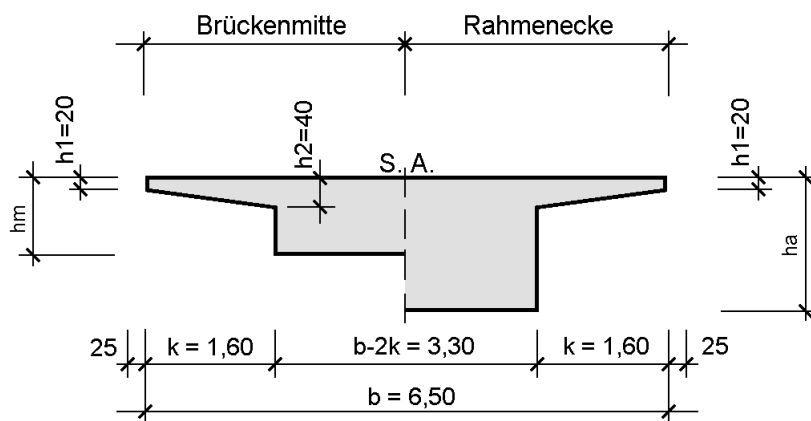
Wirtschaftswegbrücke, Querschnitt für SOFiSTiK
